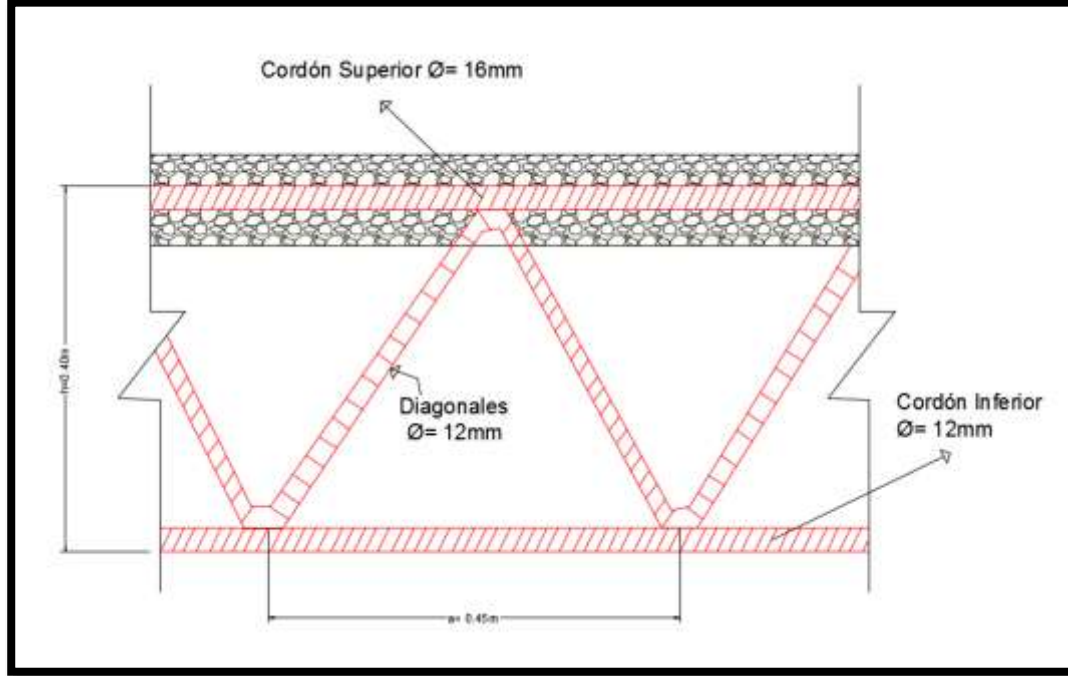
Detalle de una Sección de losa de Entrepiso Rectangular
